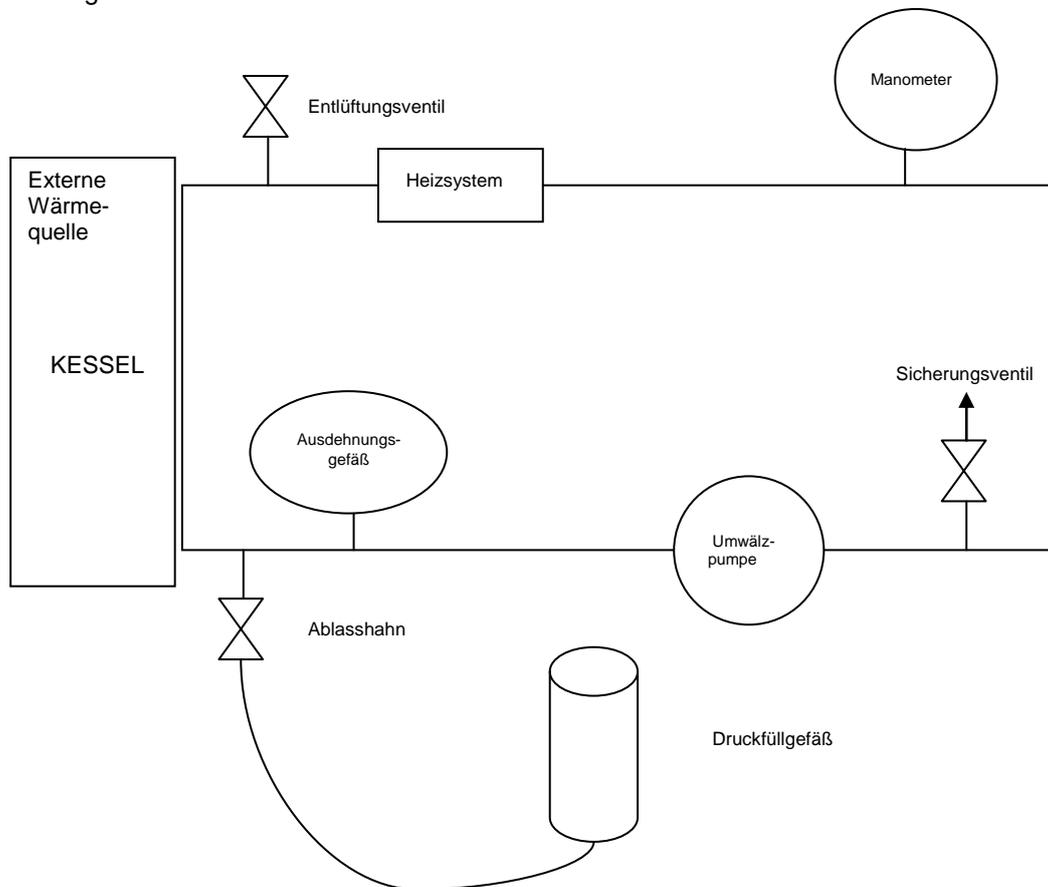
Anschlussplan für Kreislauf zur Reinigung der Trinkwasserverteilungen
